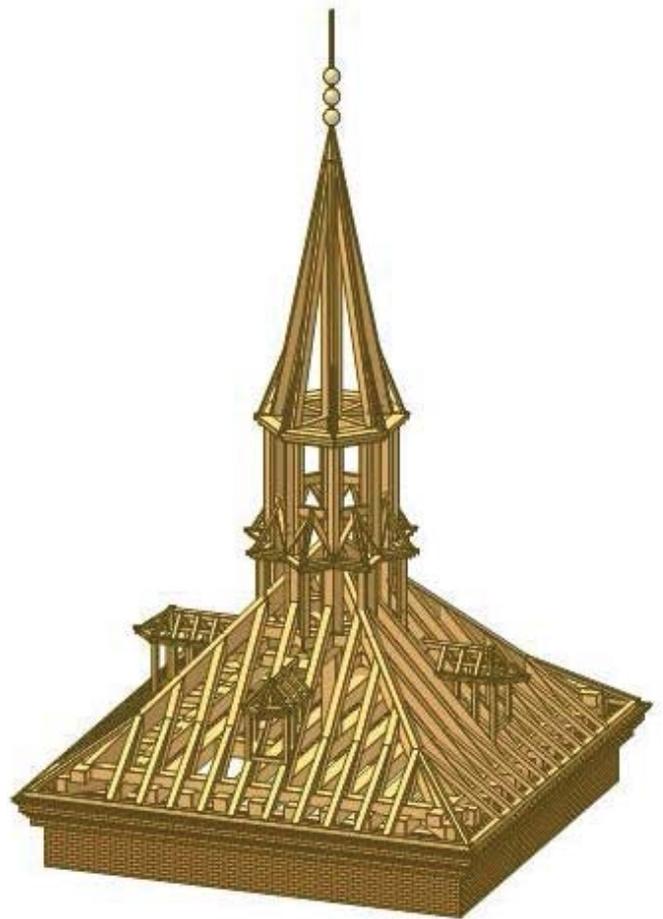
levantamiento completo de la armadura del chapitel Idem anterior
